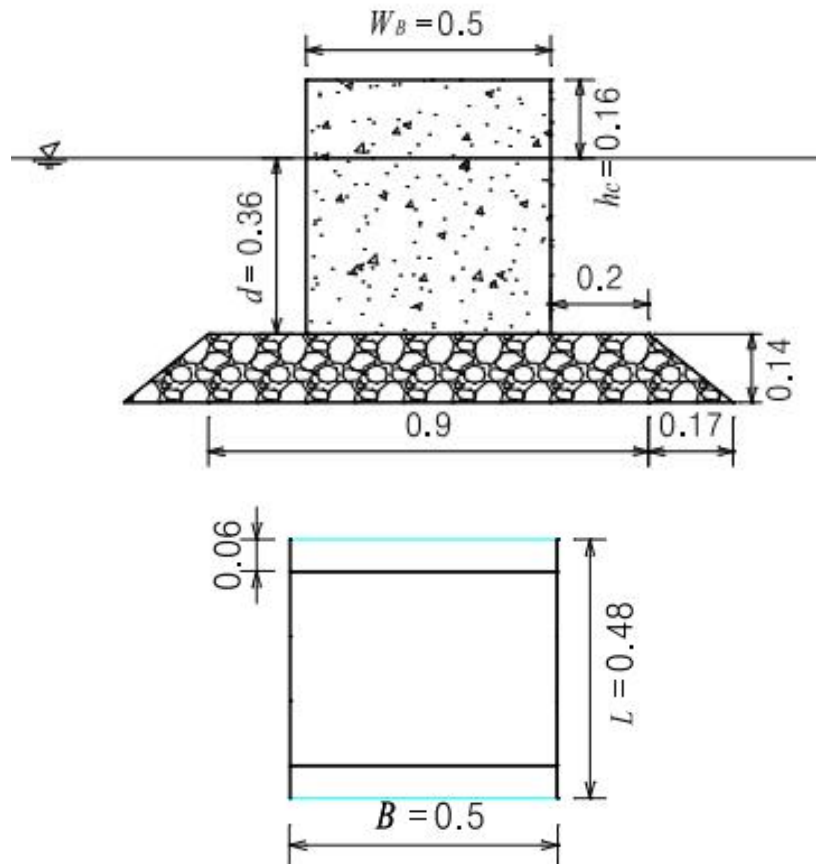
수리실험 케이슨 측면도 및 평면도
